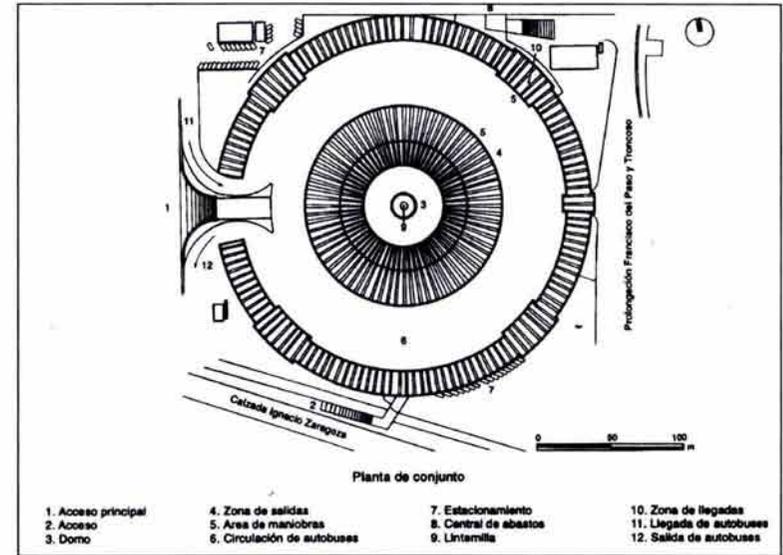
PLANTA DE CONJUNTO (TAPO)
